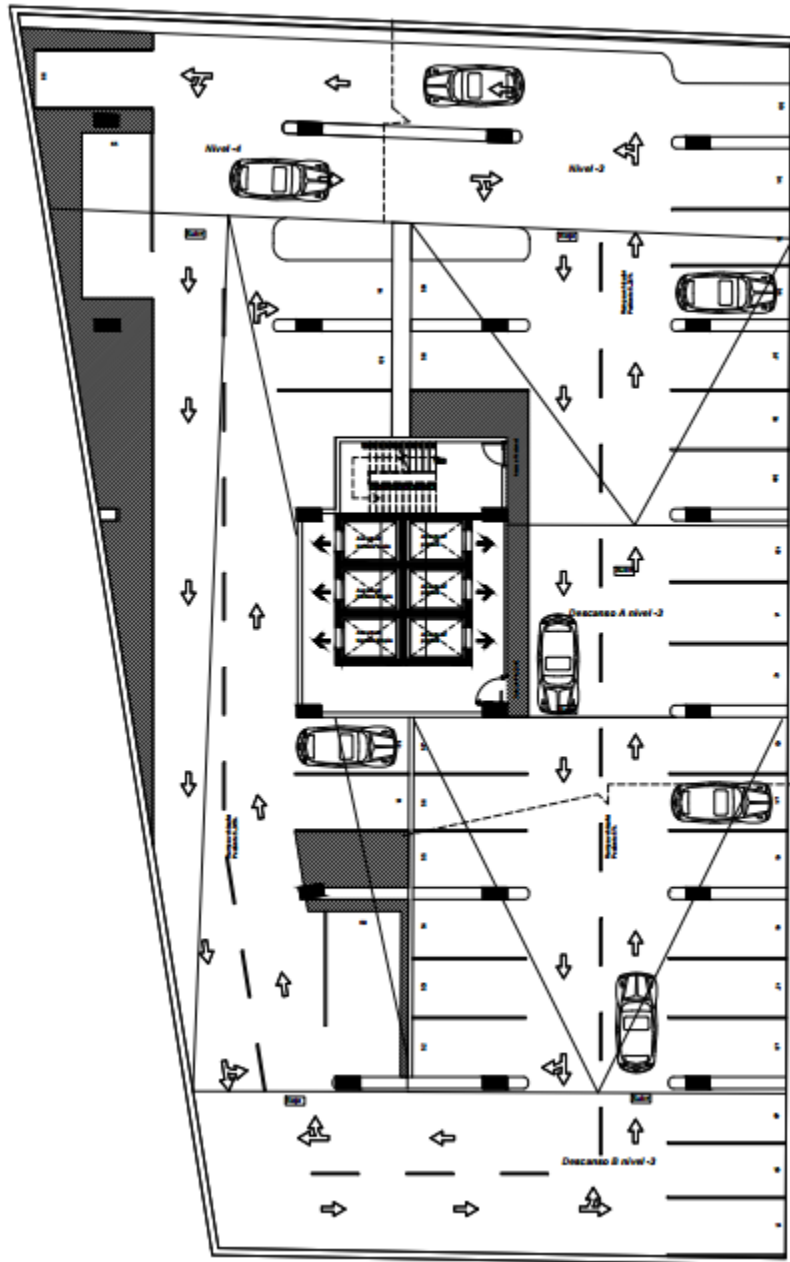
Vista en planta de los pisos -3 hasta -6
